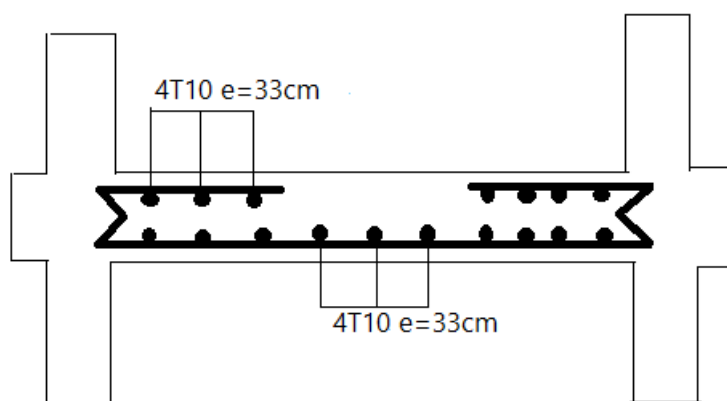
Schéma de Ferrailage de la dalle machine.
